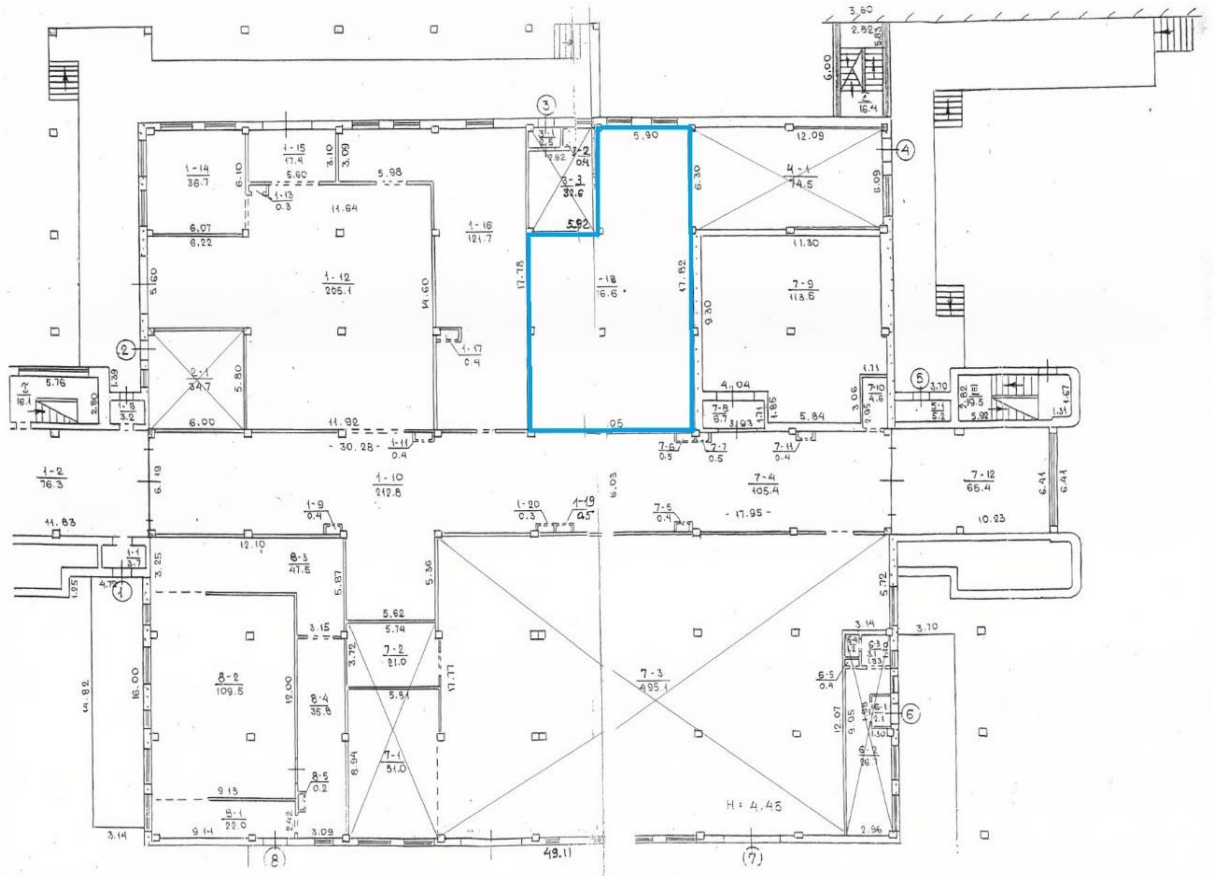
Схема загального плану будівлі просторового розташування в ній складських приміщень.
